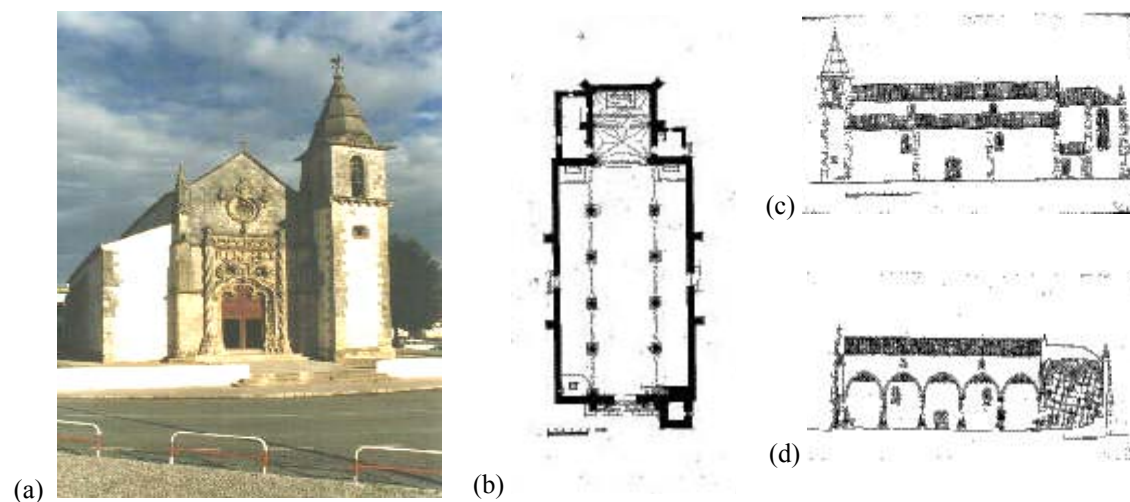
Peças desenhadas [Fonte: DGEMN]: (a) fotografia; (b) planta; (c) alçado lateral; (d) corte longitudinal.
